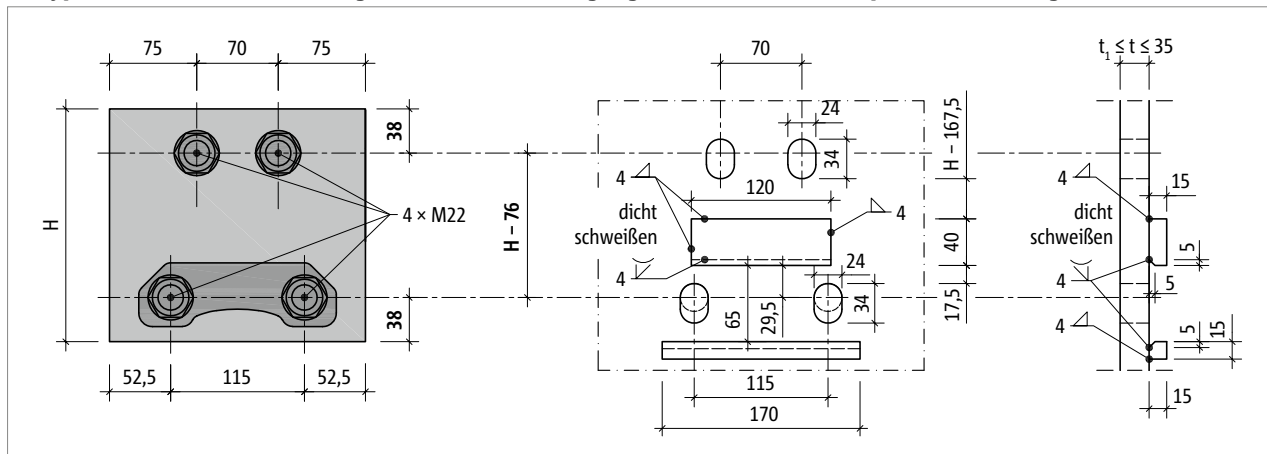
Schöck Isokorb® XT Typ SK-MM2...-CV28: Konstruktion des Stirnplattenanschlusses mit Betondeckung CV28; Rundlöcher unten, alternativ Langlöcher und eine zweite Knappe zur Übertragung der negativen Querkraft
